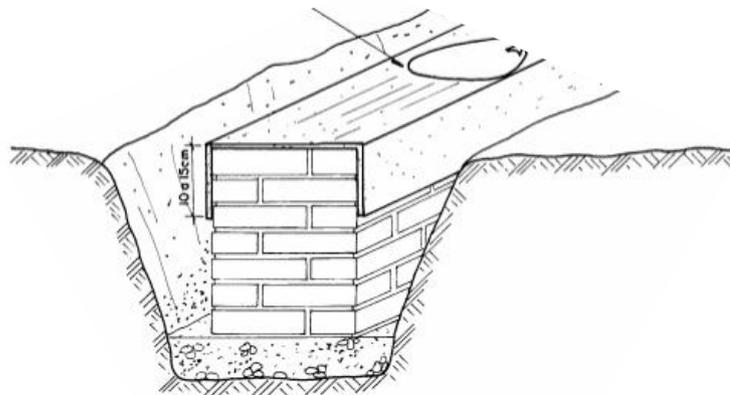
Impermeabilização da Fundação. Fonte: (MILITO)
